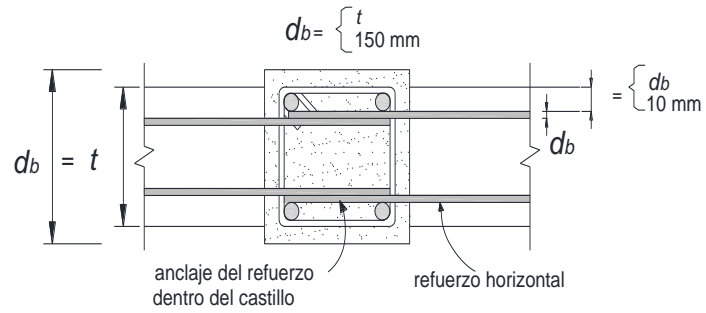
Detalle en planta del refuerzo horizontal, fuente: NTC CDMX 2017
